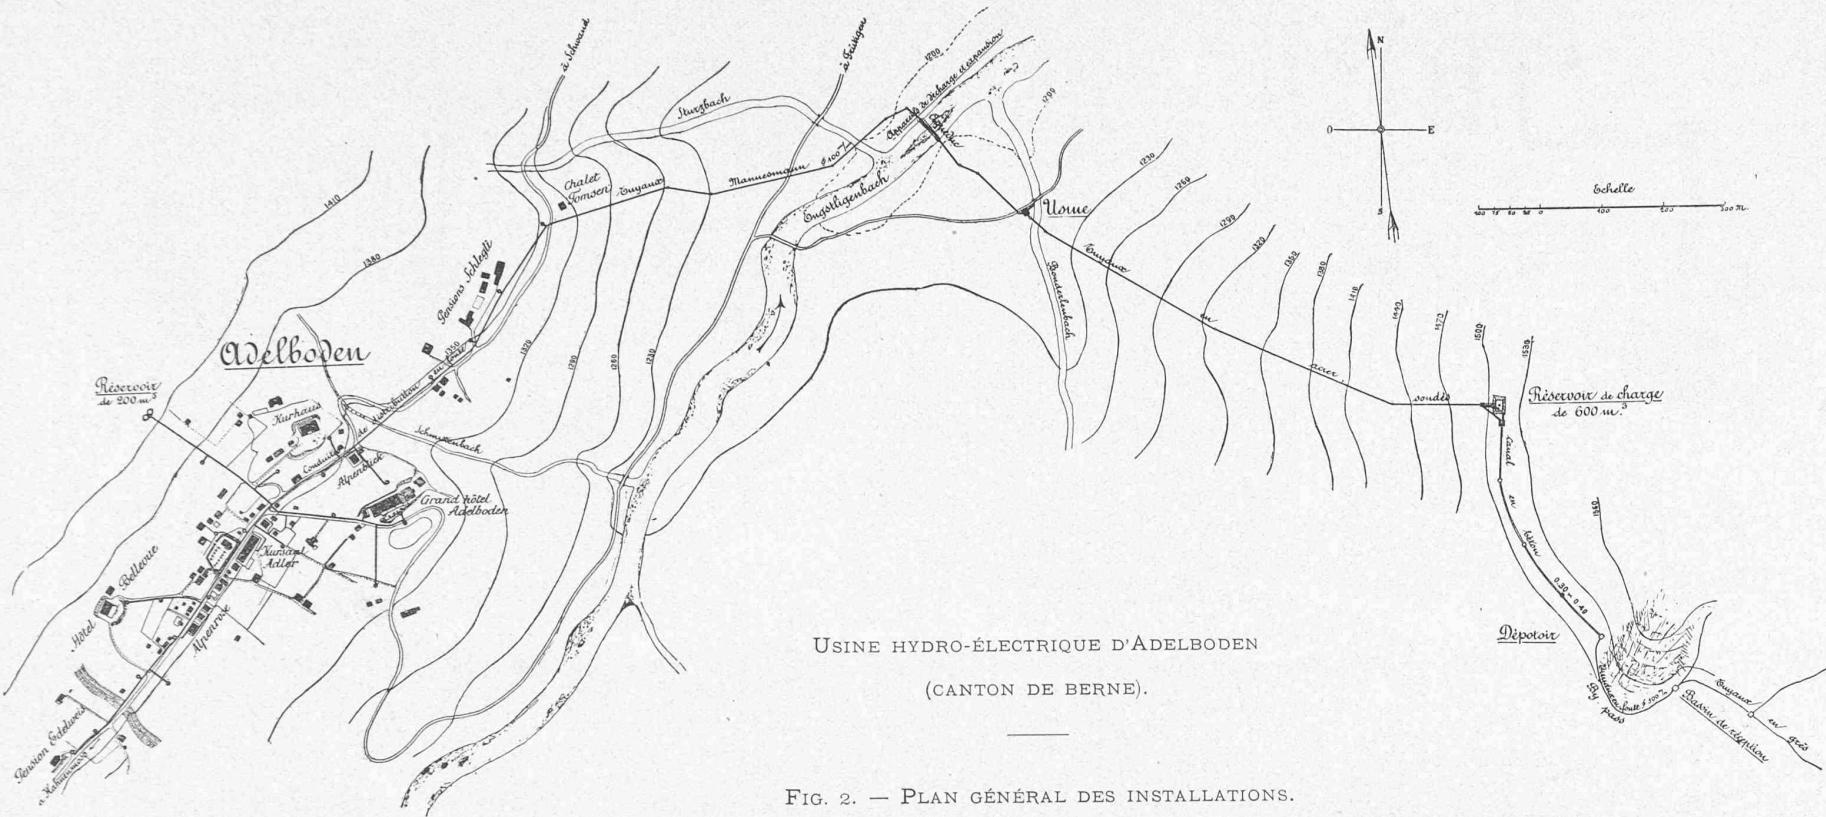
PLAN GÉNÉRAL DES INSTALLATIONS.
